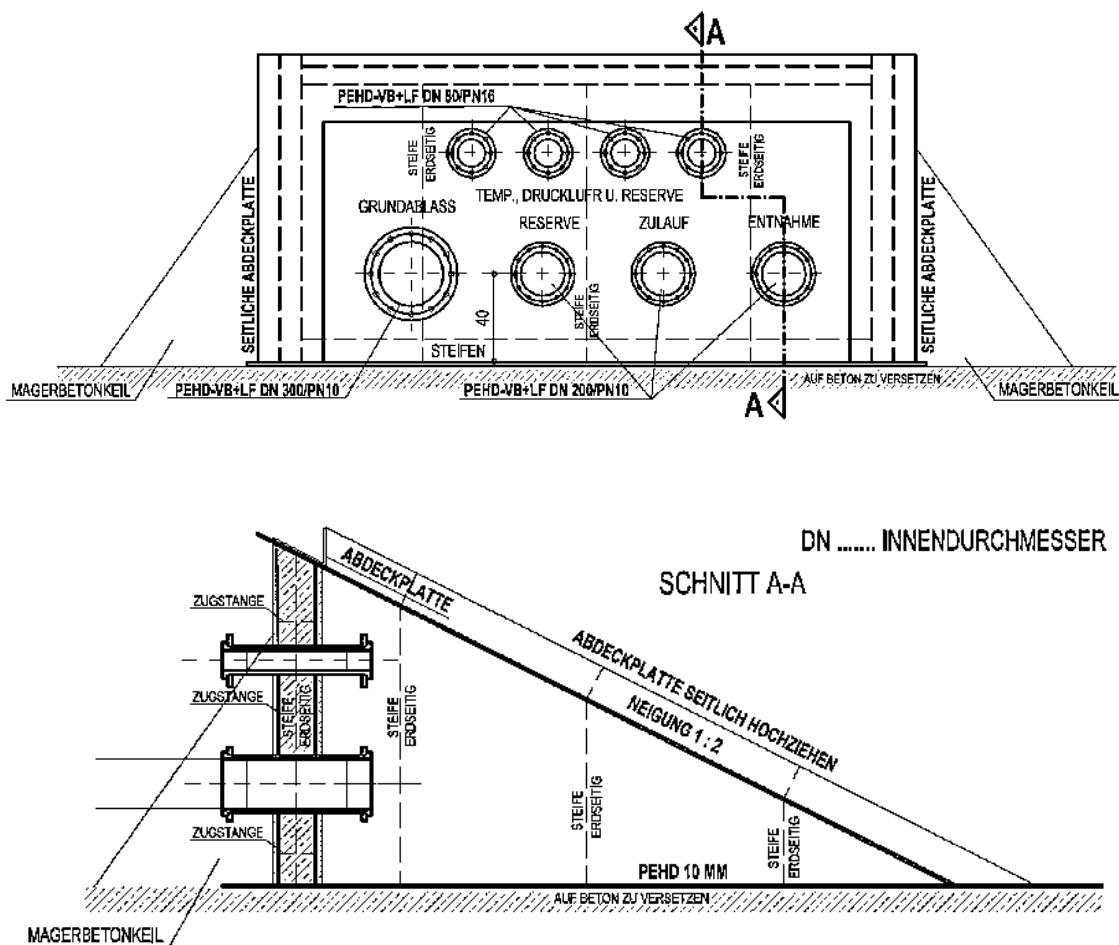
PEHD-Durchführungsbauwerk [59: S. 109]
